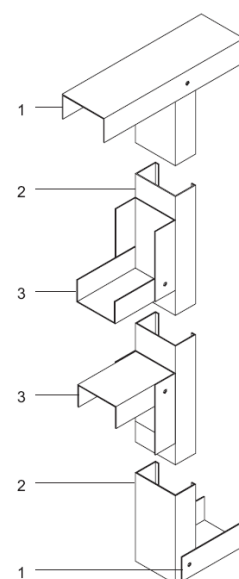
Сопряжение профилей для создания проема перемычки в каркасной конструкции
